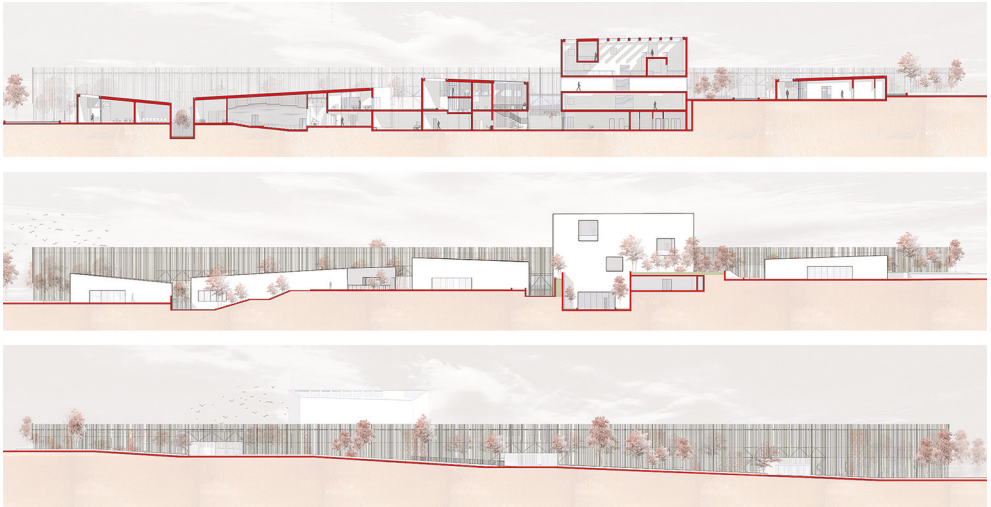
Sezione longitudinale e prospetti nord e sud del centro culturale oggetto di studio.
